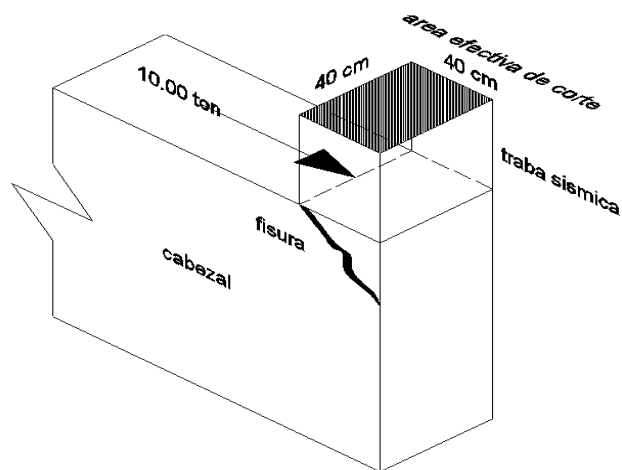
ISOMETRÍA DE LA SECCIÓN FISURADA
